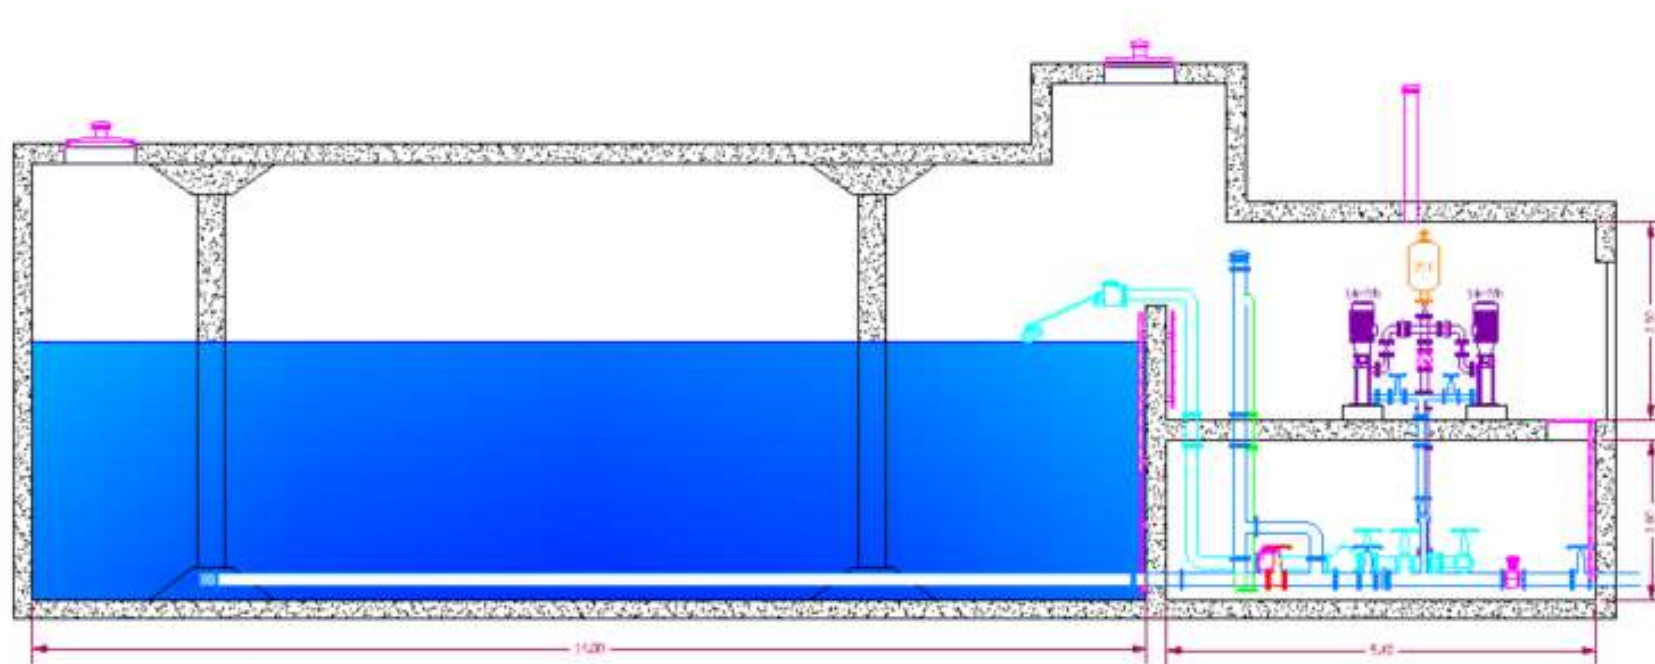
Plan en coupe du projet – Cuve et chambre à vannes
